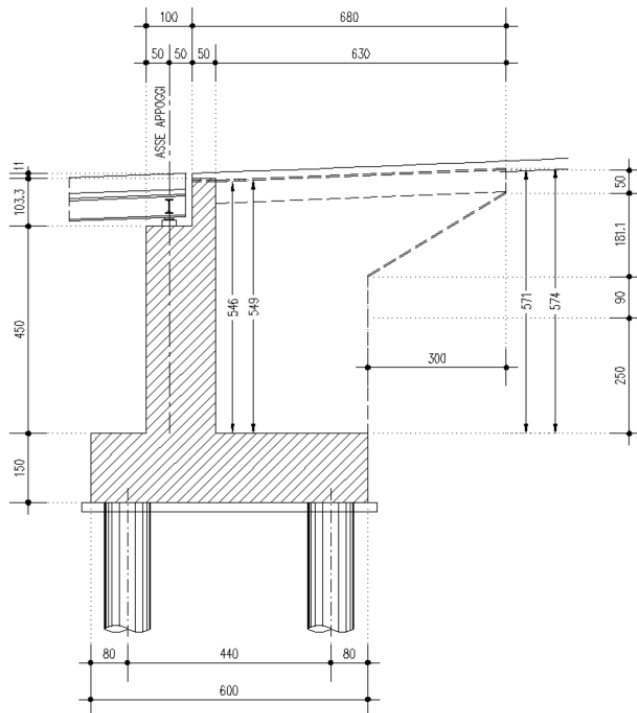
Spalla A – Sezione in asse tracciamento
